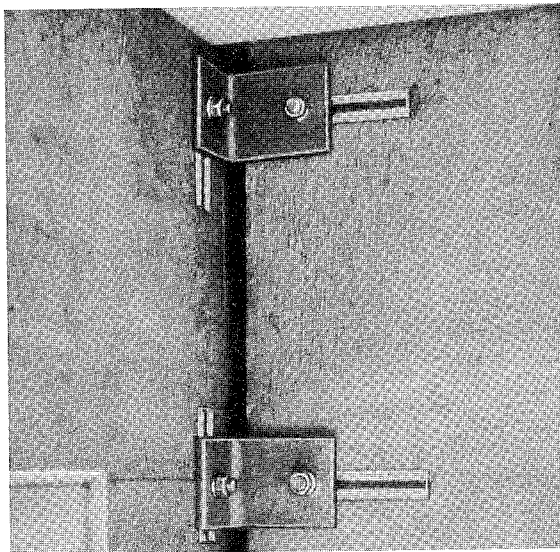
Anschluß eines Holzbinders an den Stahlbetonringbalken
